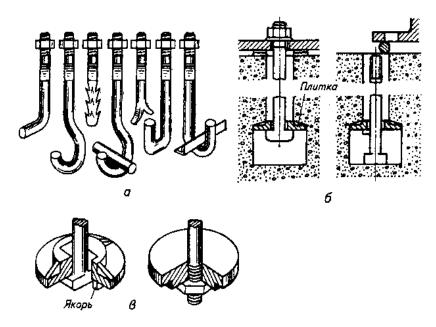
Фундаментные болты: a — заливной; δ — фундаментный; ϵ — варианты крепления нижнего конца фундаментного болта
